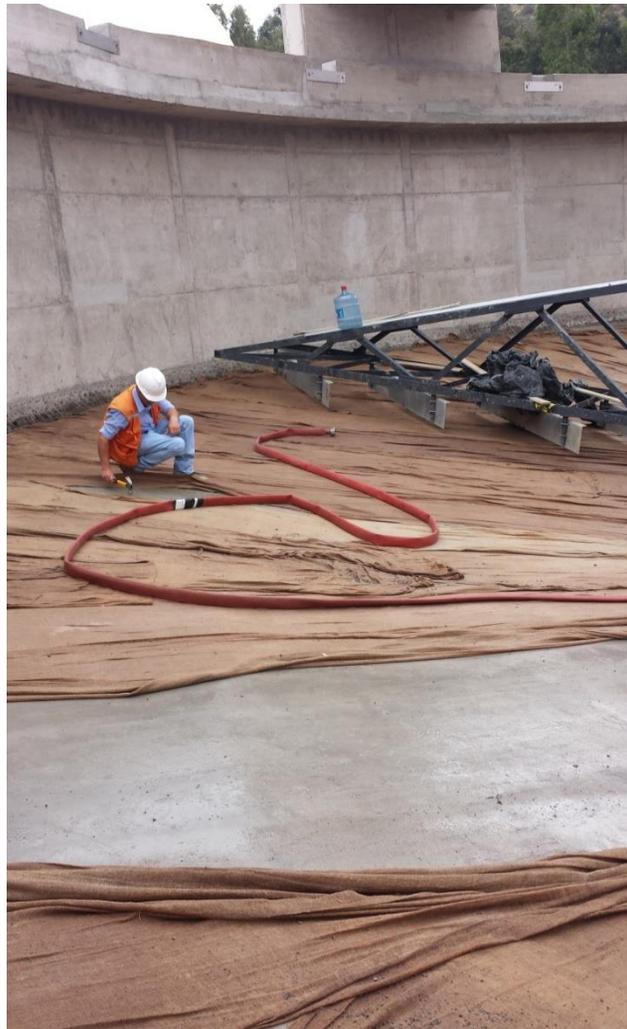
ITO inspeccionando la losa(fuente: foto tomada durante la práctica)
